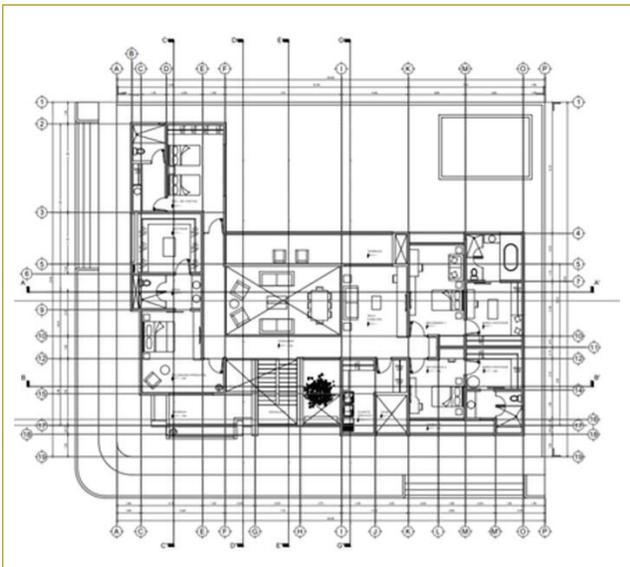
Planta arquitectónica baja del proyecto que se va a diseñar.
